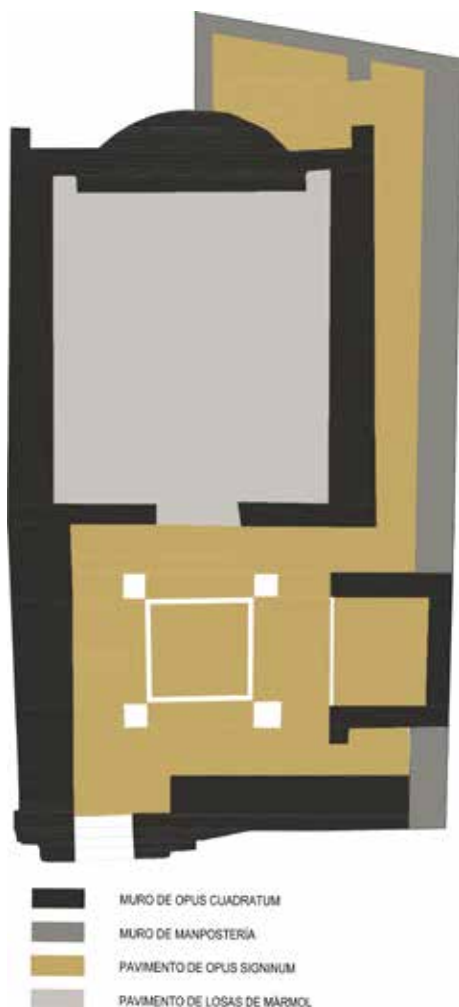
Situación en planta de los diferentes tipos de muro y pavimento. Fuente: Elaboración propia.
